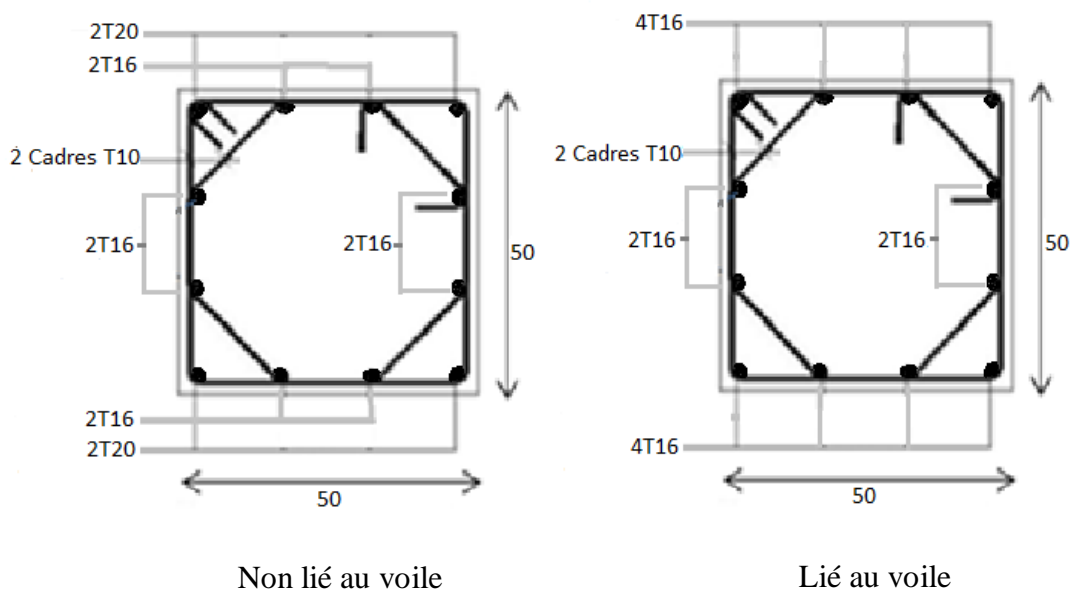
Ferraillage des poteaux de 1^{ère} et de 2^{ème} étage.
